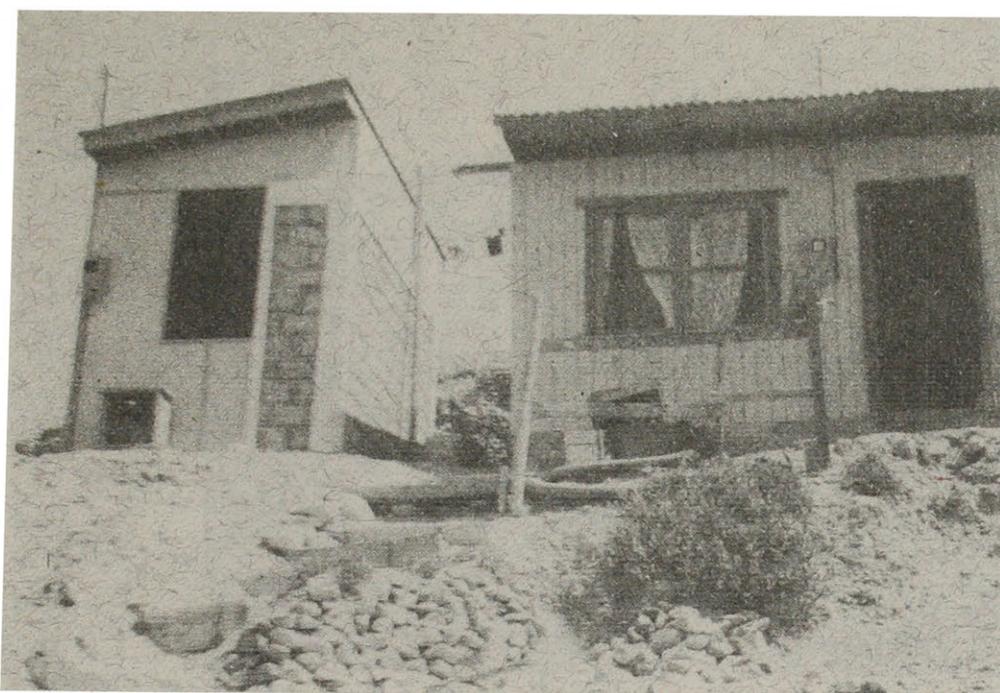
Caseta Sanitaria con sistema constructivo de Albañilería de Bloques de Cemento en la Tercera Región. Julio 1993.
